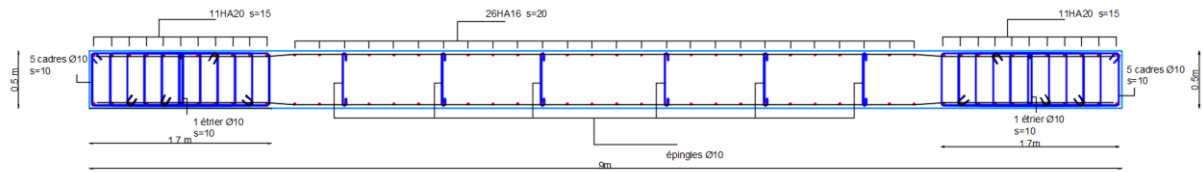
Ferrailage de voile sur la hauteur critique.
